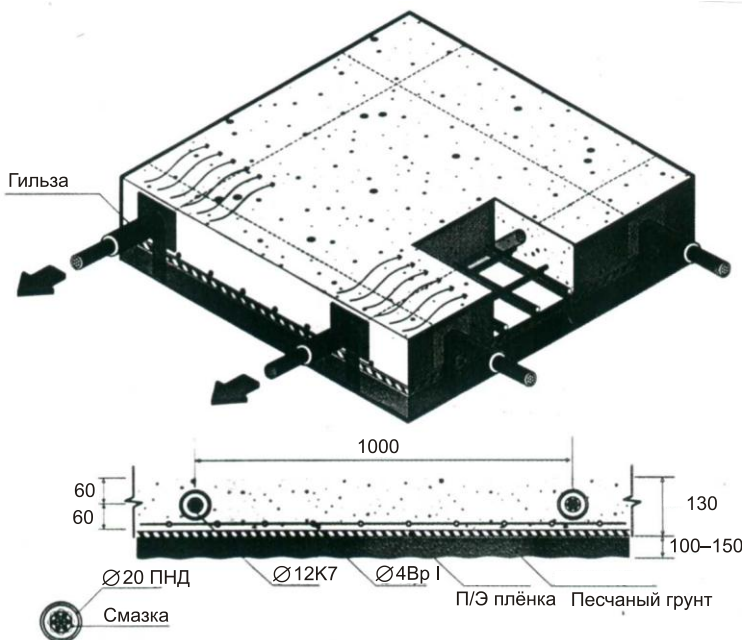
Железобетонная плита для устройства основания пола на слабых и промороженных грунтах
